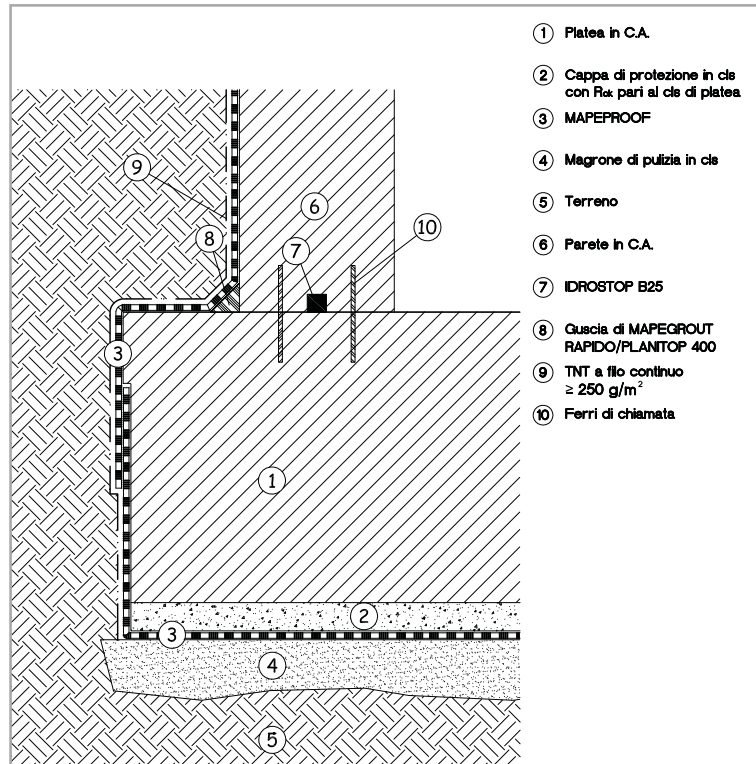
Particolare tecnico dell'impermeabilizzazione in post-getto con MAPEPROOF
